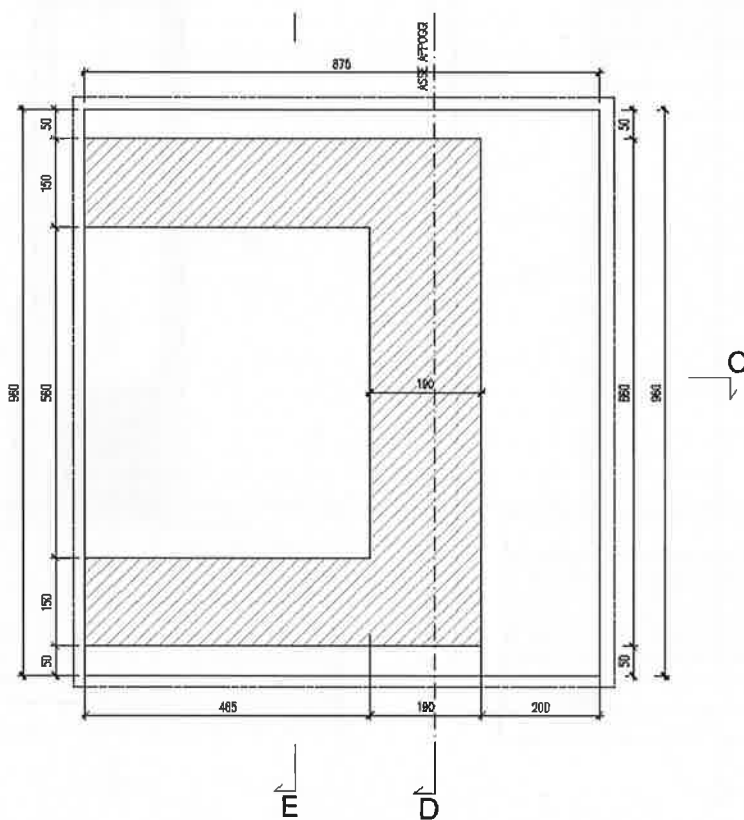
Pianta fondazione spalle, Bonorva VI02
